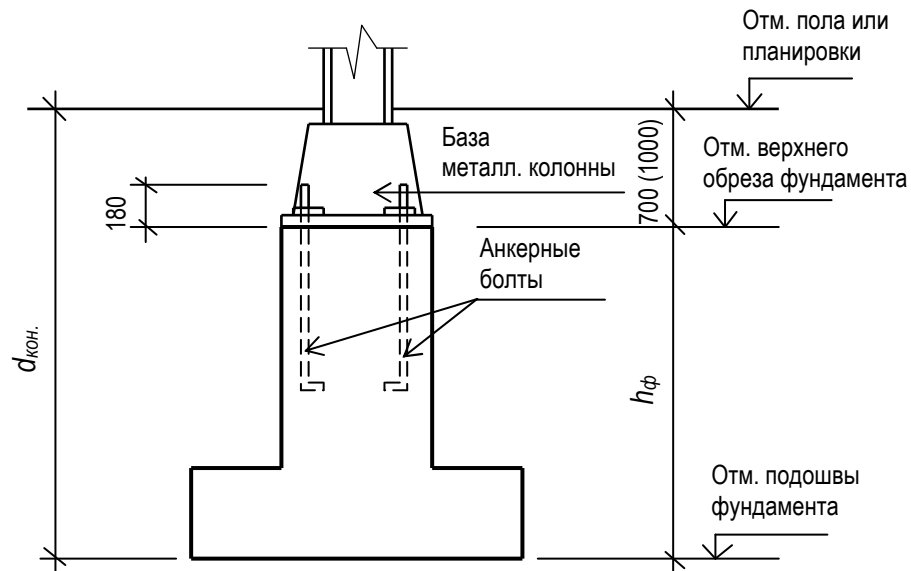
Предварительное конструирование отдельного (столбчатого), монолитного фундамента под металлическую колонну. Вариант – без подвала
